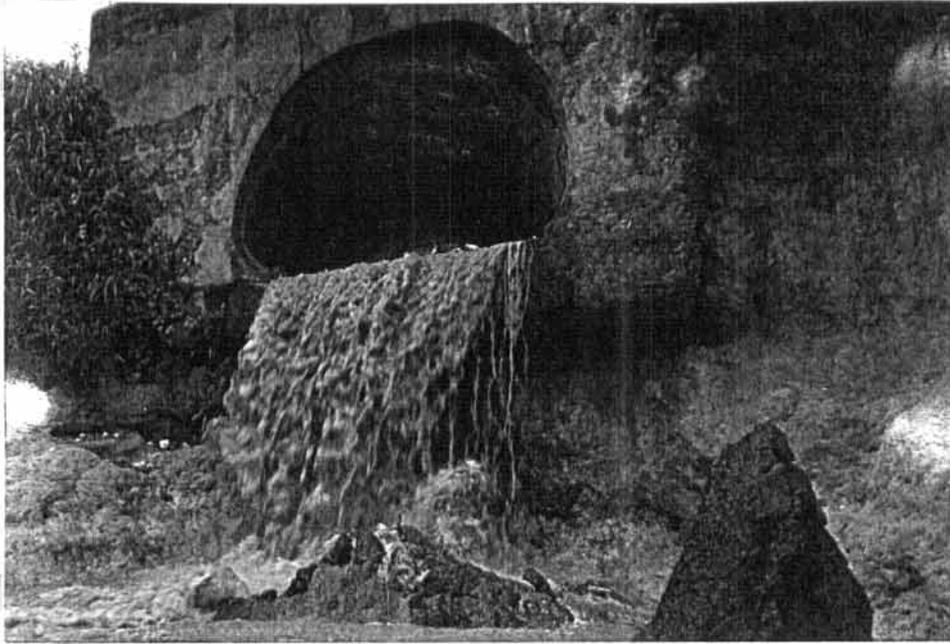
Effondrement partiel du pont N°4. Constat : la dalle inférieure est suspendue à 2 m du lit de la ravine d'où accentuation de l'affouillement
